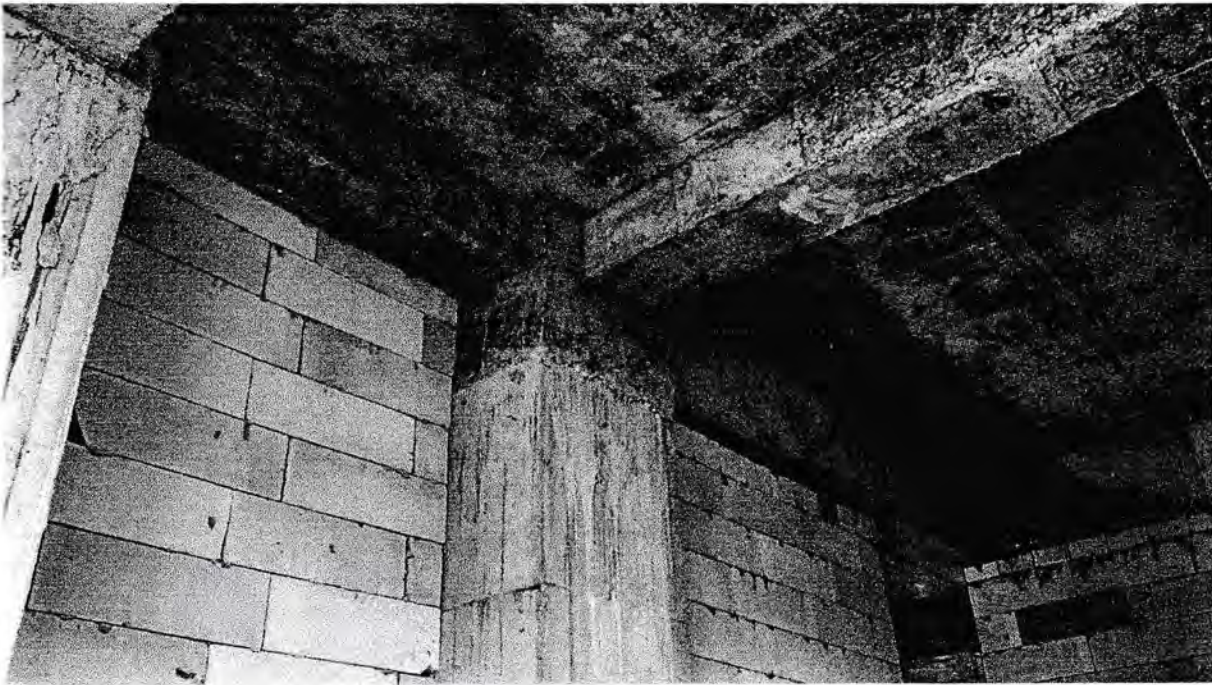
proses pelepasan beskisting balok dan plat
